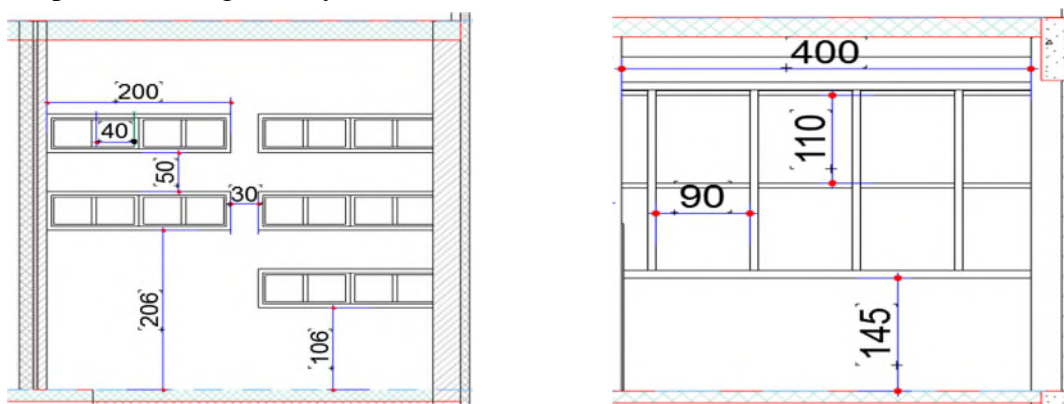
coupe sur la paroi nord-ouest avant correction (source : auteures, 2021).
